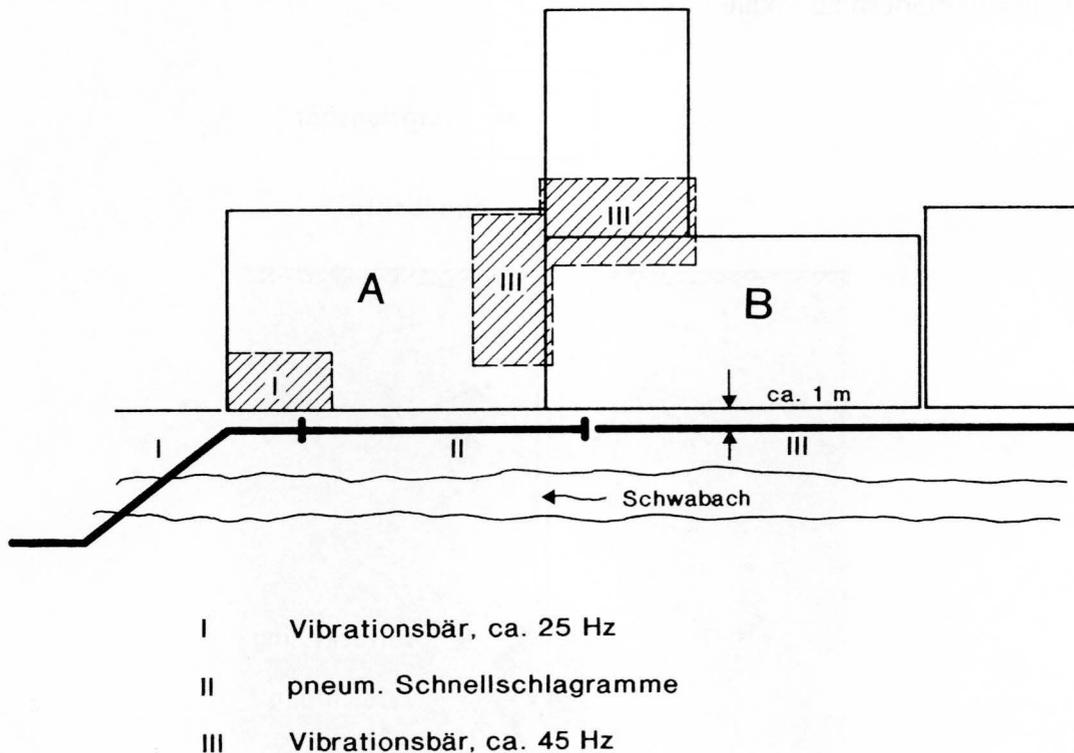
Schadensfall an einem Gebäude in Schwabach durch ESB-Effekt; Lageplan
